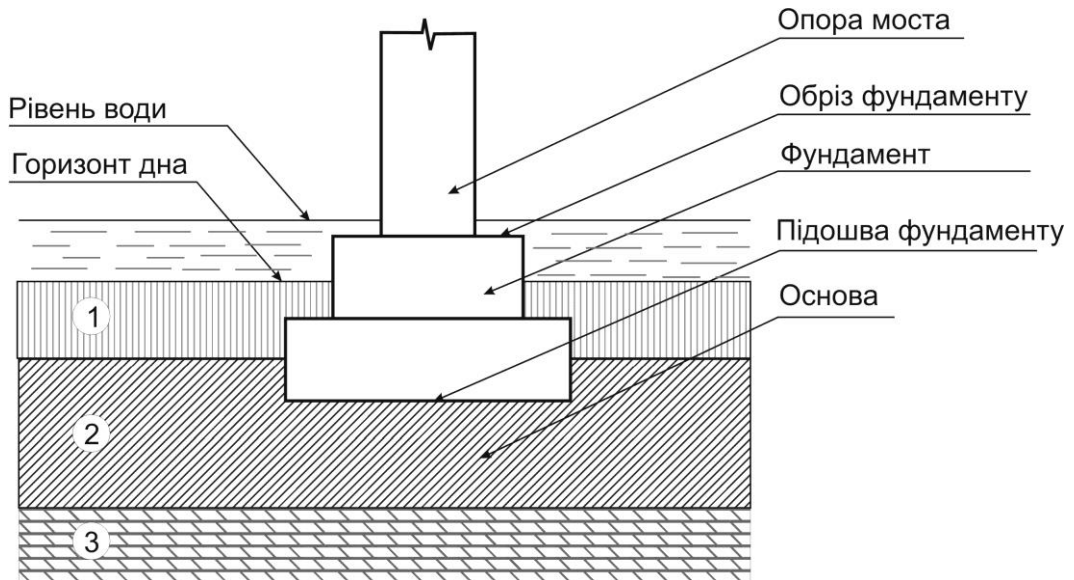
Фундамент неглибокого закладення на акваторії
